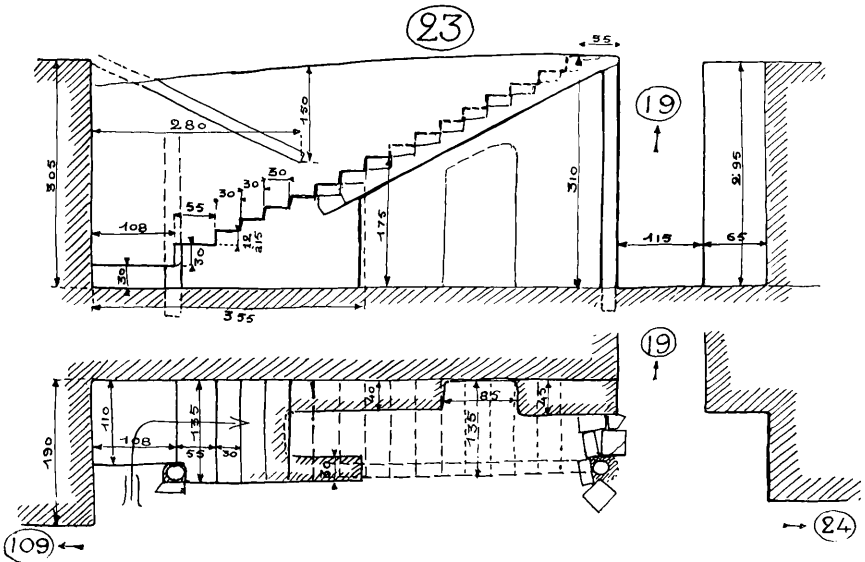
Salle 23. Plan et coupe de l'escalier montant à la terrasse.
